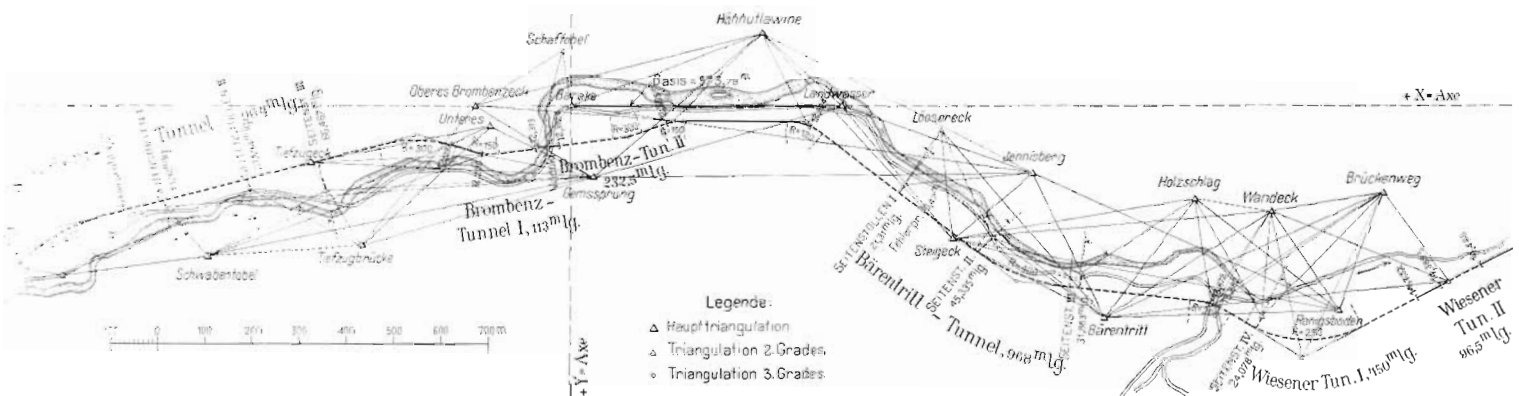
Triangulation der Tunnelstrecke in den «Zügen». — Masstab 1 : 16000.
